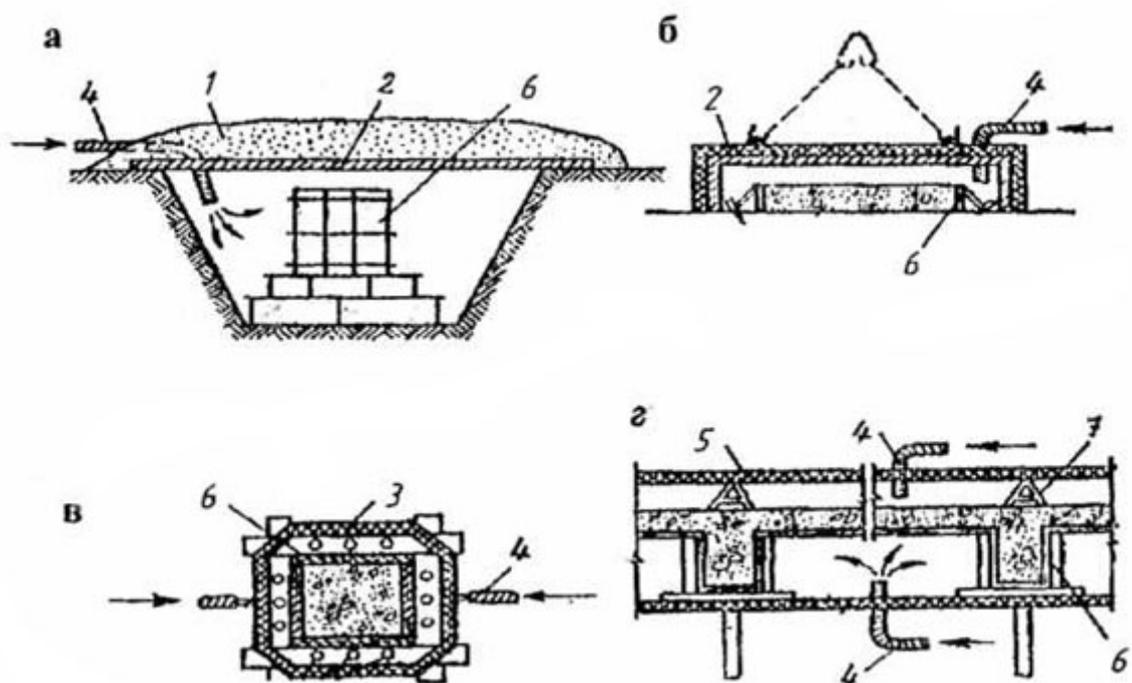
Схемы устройства опалубки при обогреве железобетонных конструкций паром: а – обогрев фундаментов; б – обогрев бетонных плит (полов, площадок); в – капиллярная опалубка для прогрева колонны; г – обогрев ребристого перекрытия; 1 – утеплитель; 2 – съемный короб; 3 – короб колонны; 4 – подача пара; 5 – короб плиты перекрытия; 6 – опалубка; 7 – отверстия в ребрах короба для пара
